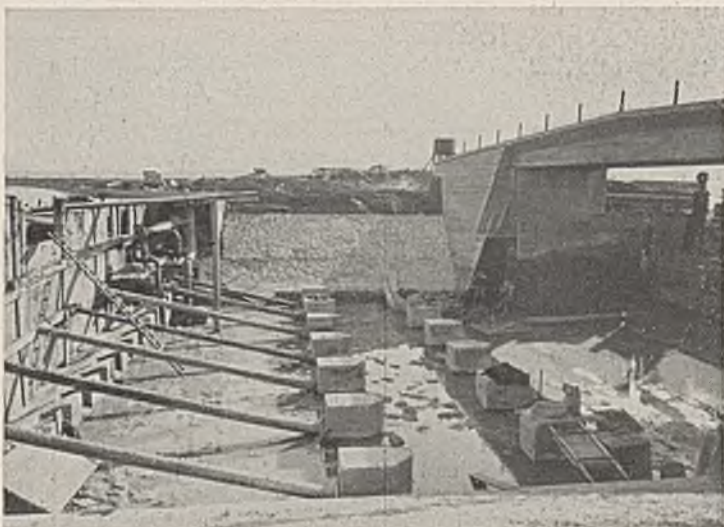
Laderbrücke und Absturzbauwerk (Überfallwehr, Bremsblöcke, Zahnschwellen) beim Hochwasserschutz an der Donau im Straubinger Becken.
